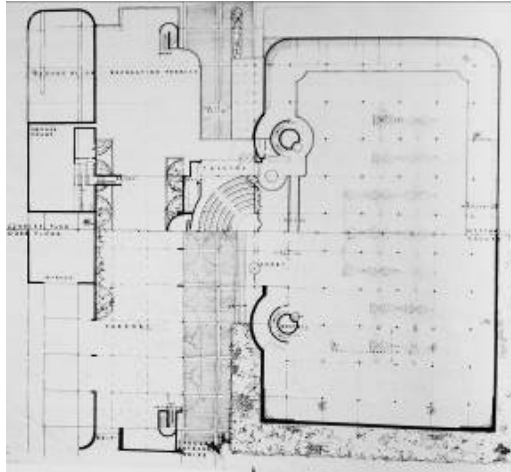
Planta de acceso y planta intermedia sobre sala de trabajo.
